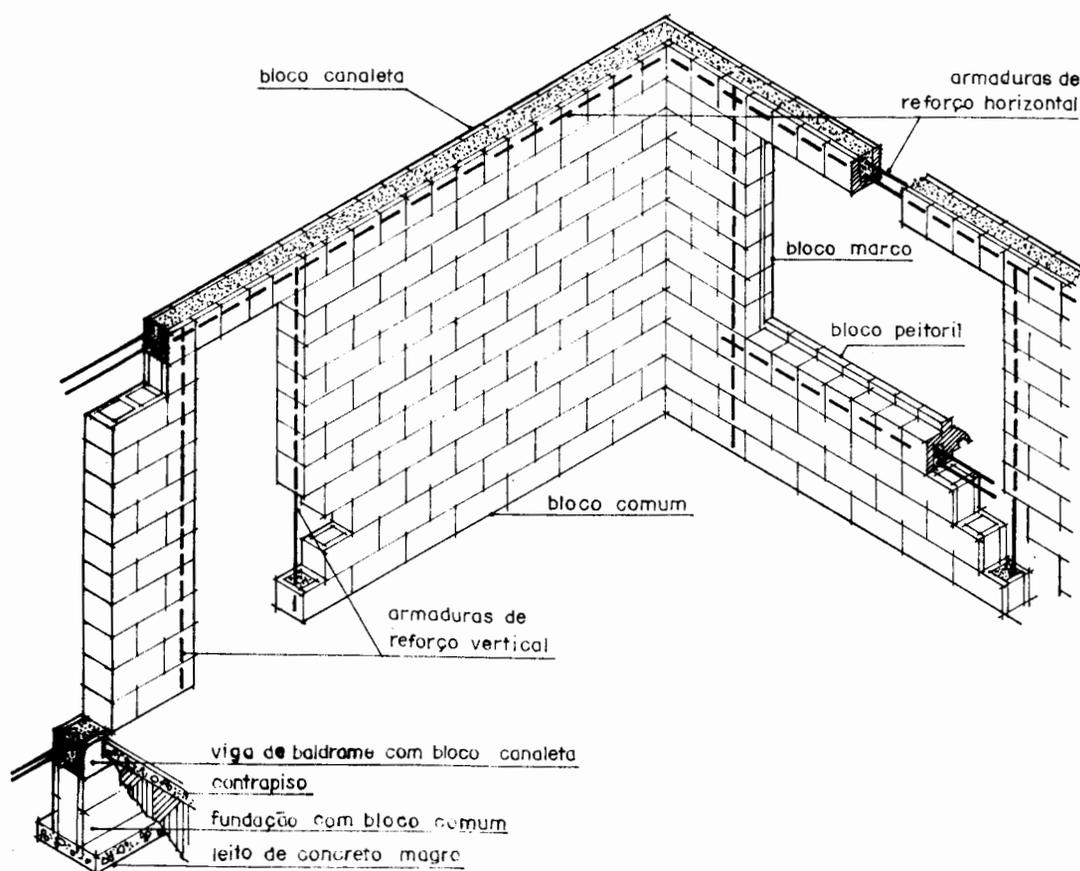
Paredes de alvenaria de blocos de concreto
